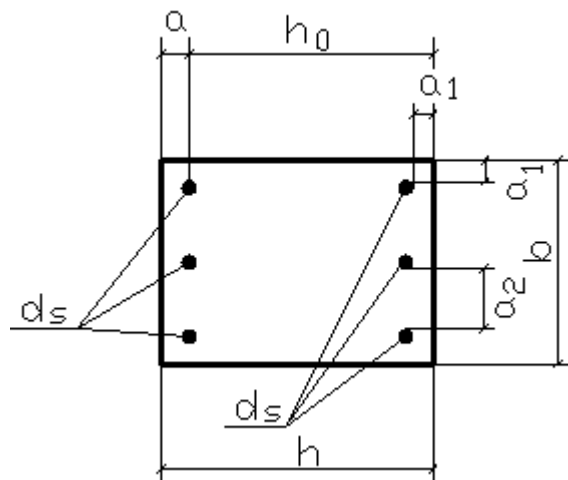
Размещение продольной арматуры в сечении стойки
